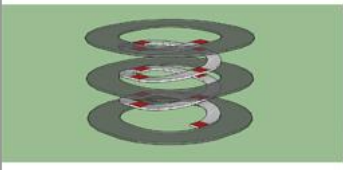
ผลลัพธ์ระยะความสูง Floor to ceiling ทางลาดลักษณะวงกลม
